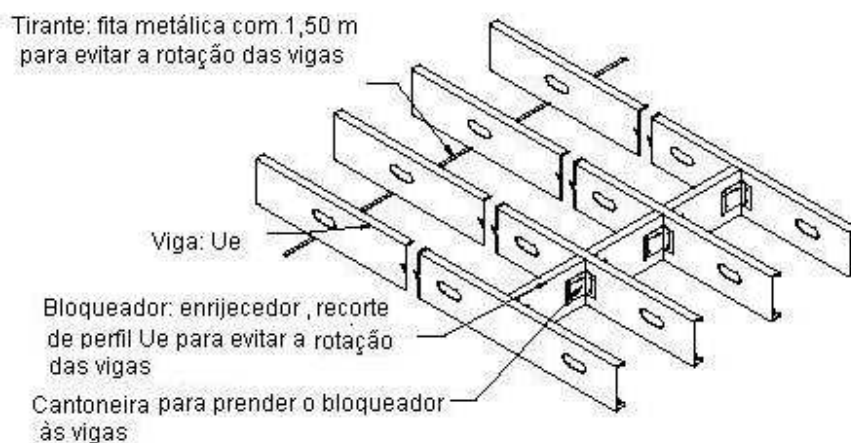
Travamento lateral de vigas, com bloqueador e fita metálica
